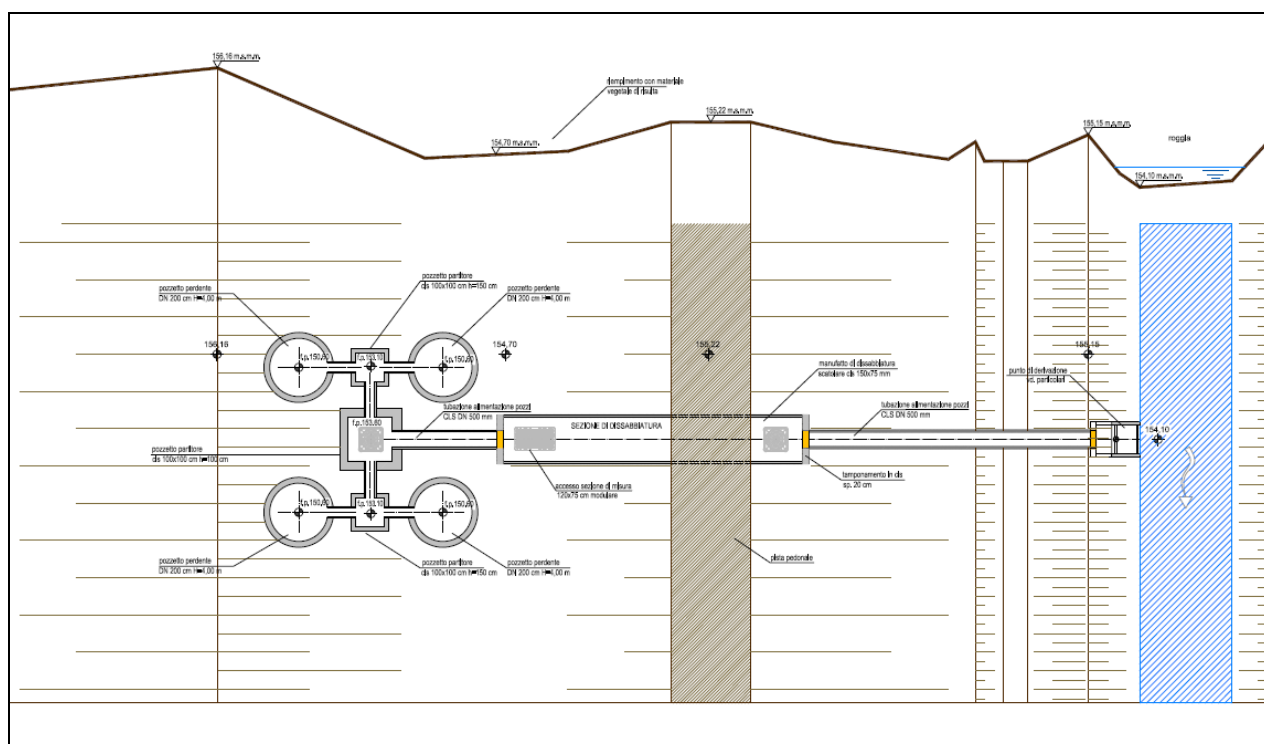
Disposizione planimetrica campo pozzi di infiltrazione
